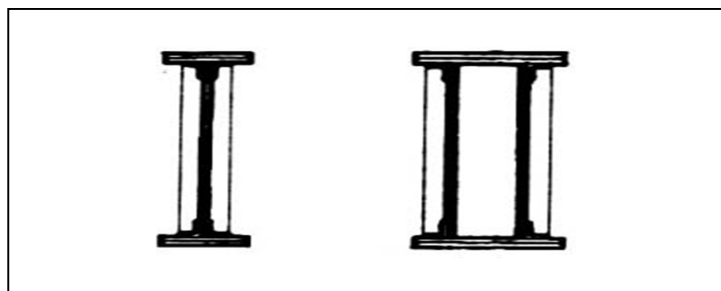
Perfiles armados en base a placas de acero (SIDOR, 1998).
